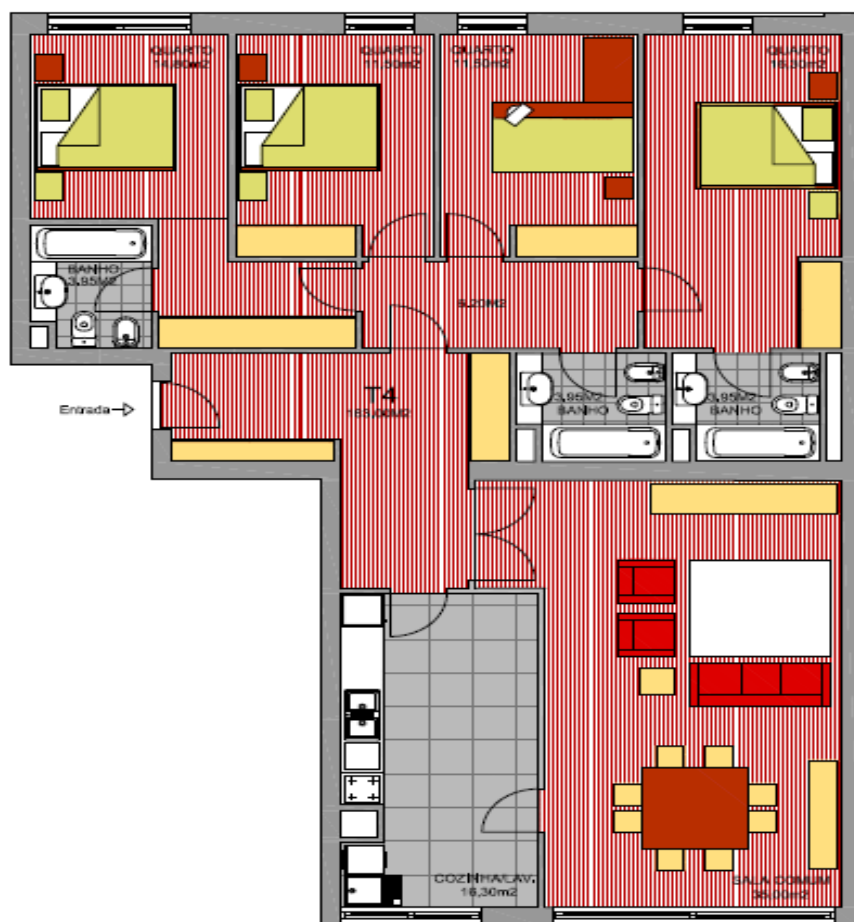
Planta de apartamento T4, utilizado no cálculo de custos de piso radiante.
